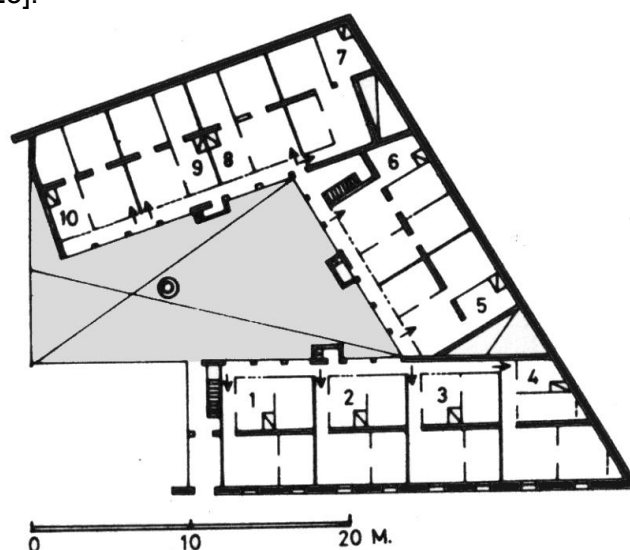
Planta de una casa de corredor levantada en 1891 en la c/ Hermosilla (Ensanche). Edificio de 4 plantas (10 viviendas por planta, de aproximadamente 30 m<sup>2</sup> de superficie). Servicios de WC y agua colectivos: 3 WC por planta y una fuente en el patio [23].
